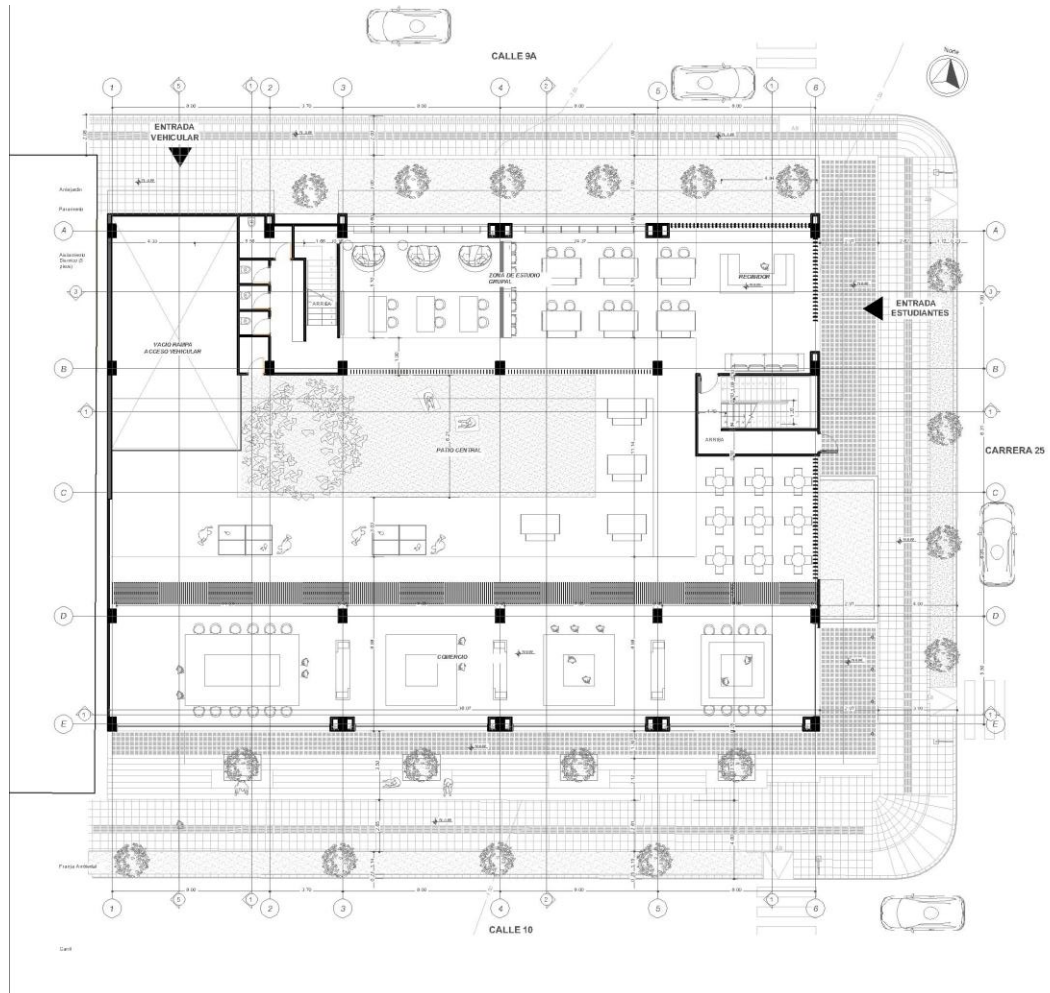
Fachada Norte*Figura 81 *Primera Planta
